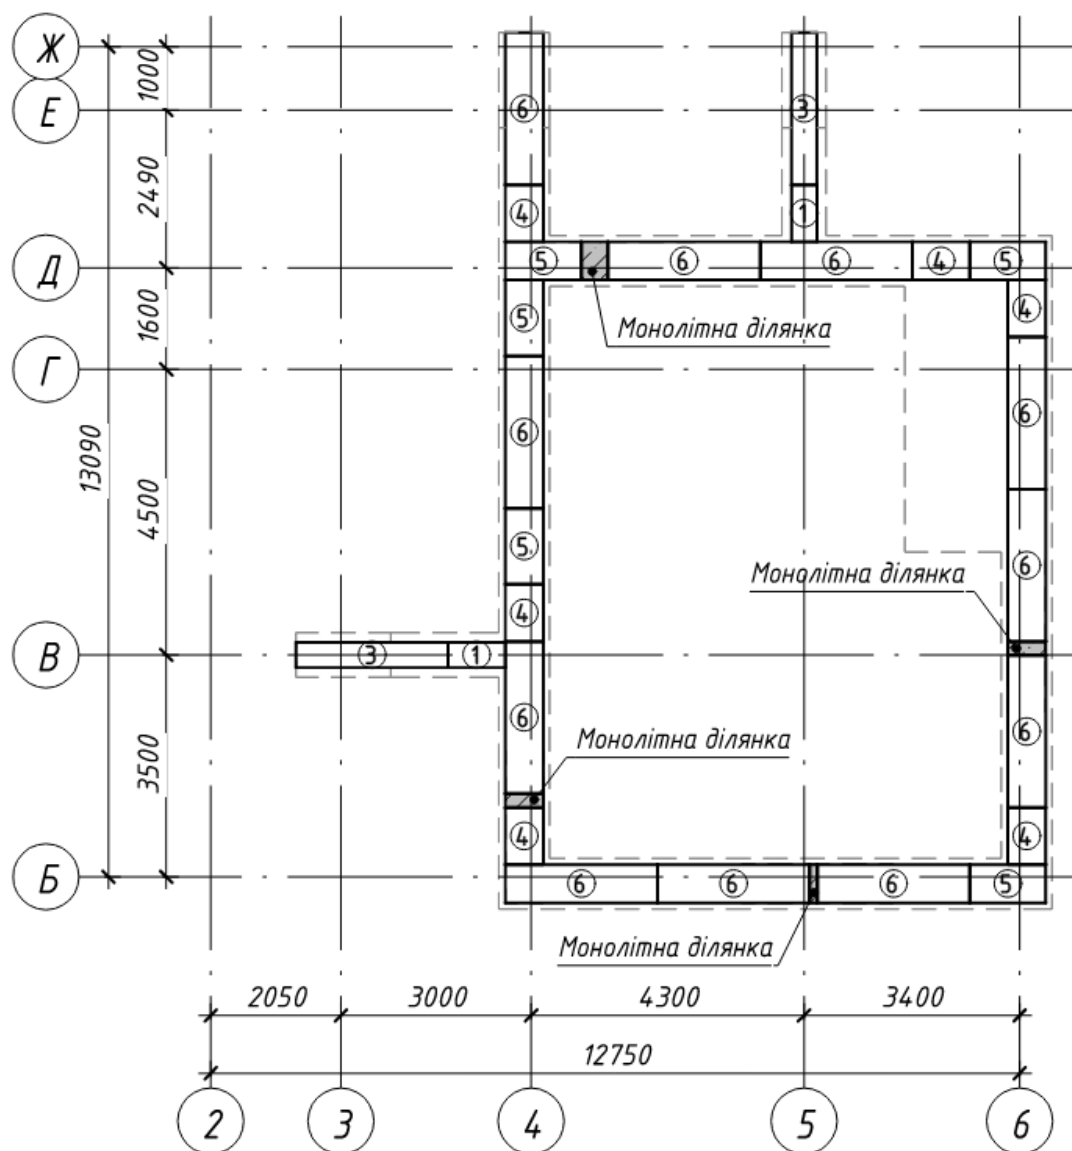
Схема розкладки блоків на відм. -3,150 (другий ряд)
